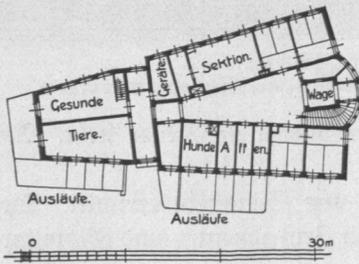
Institut für Schiffs- und Tropenkrankheiten, Tiergebäude, Erdgeschöß, Grundriß.
